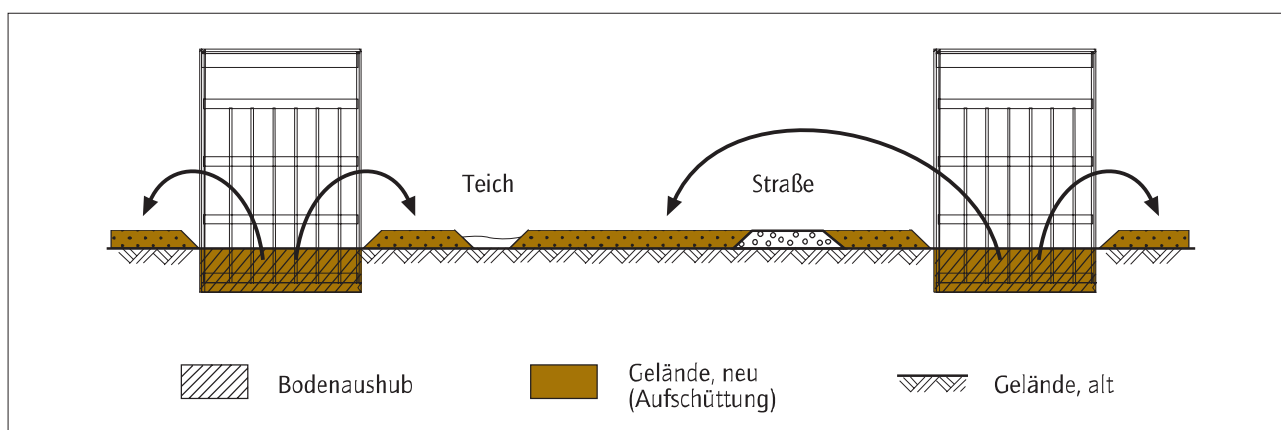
Erdmassenausgleich, schematische Darstellung. Hagelauer Consult, Walldorf.
